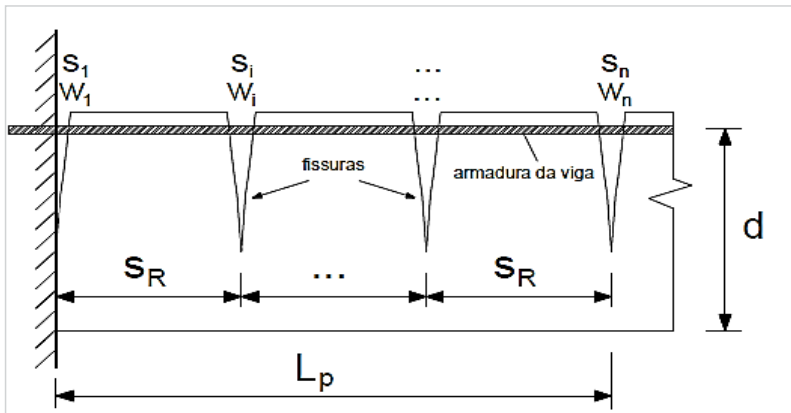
Modelo B: deslizamento das armaduras provocado pela fissuração
